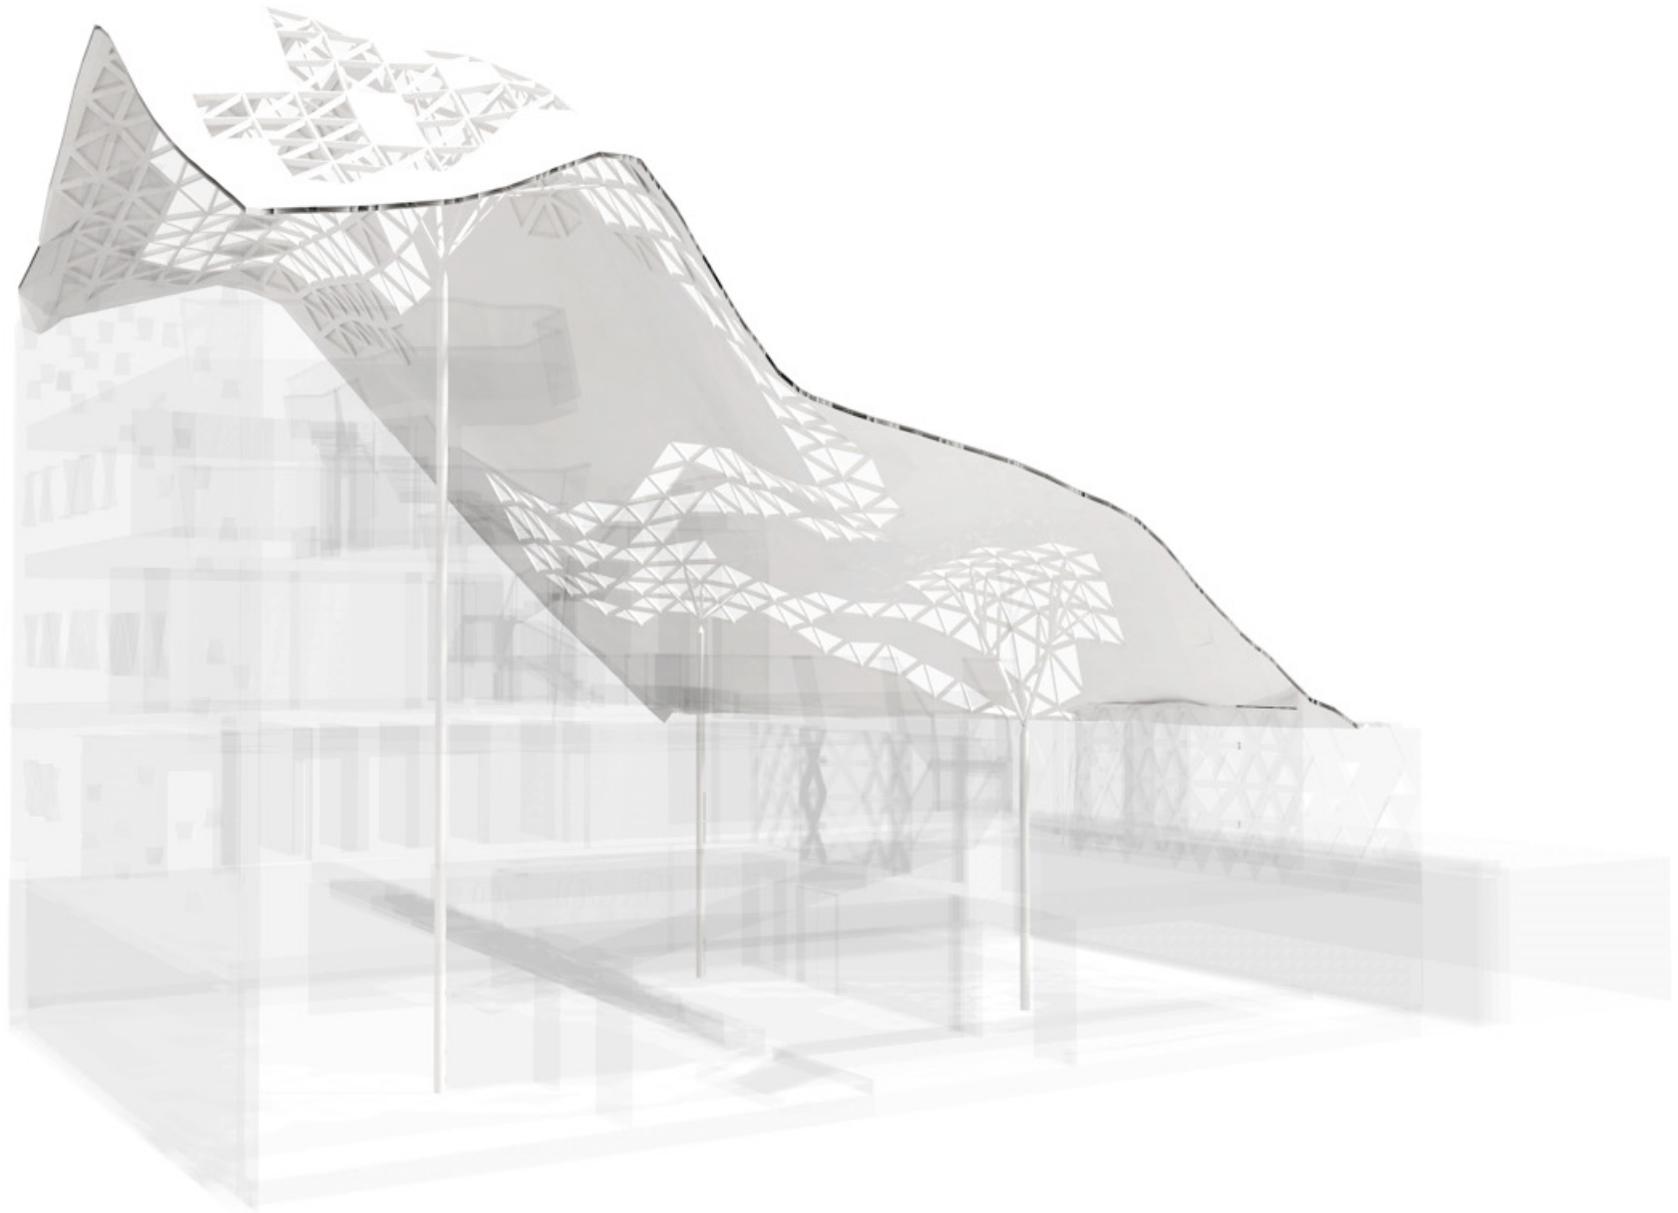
Lichtführung, Fassadenentwurf inklusive Baumstützen
